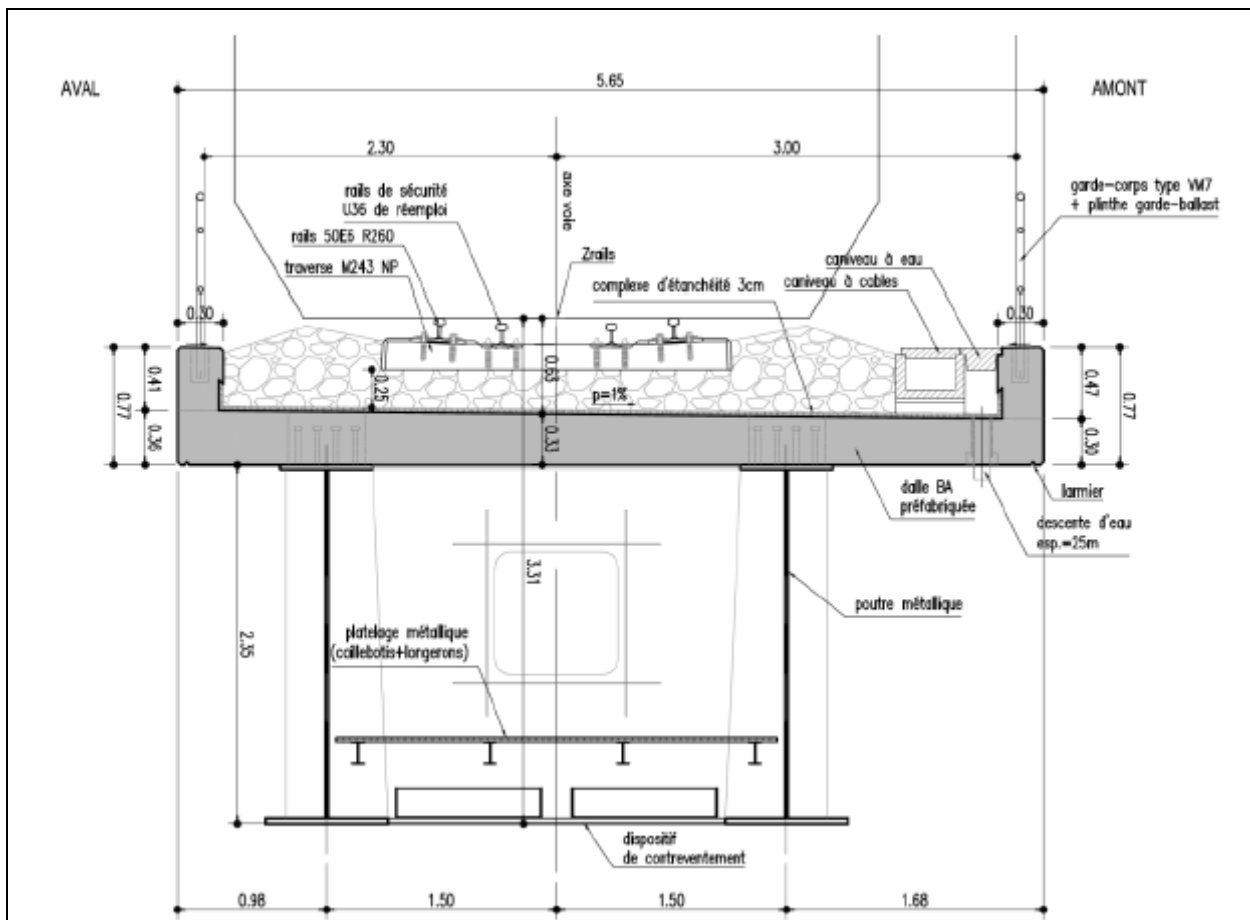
coupe en travers du tablier métallique projeté. (Source : dossier)
